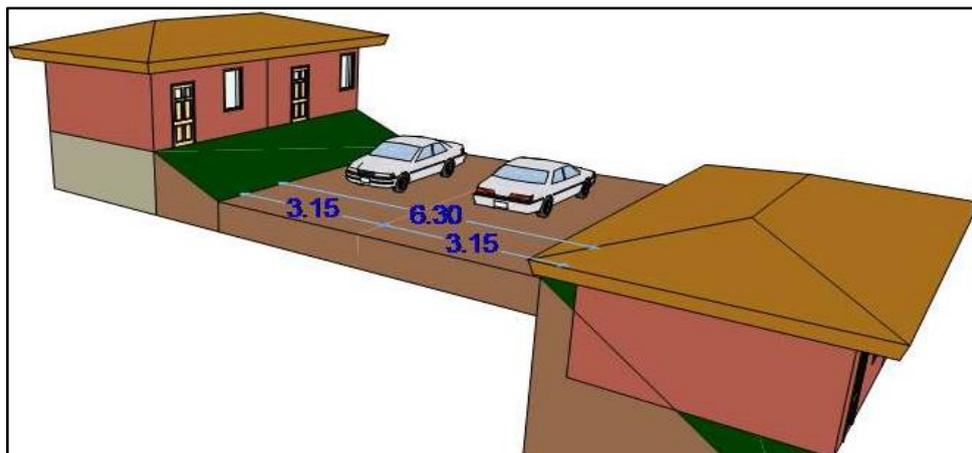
Vista 3d de Av. Héroes de Jactay.
